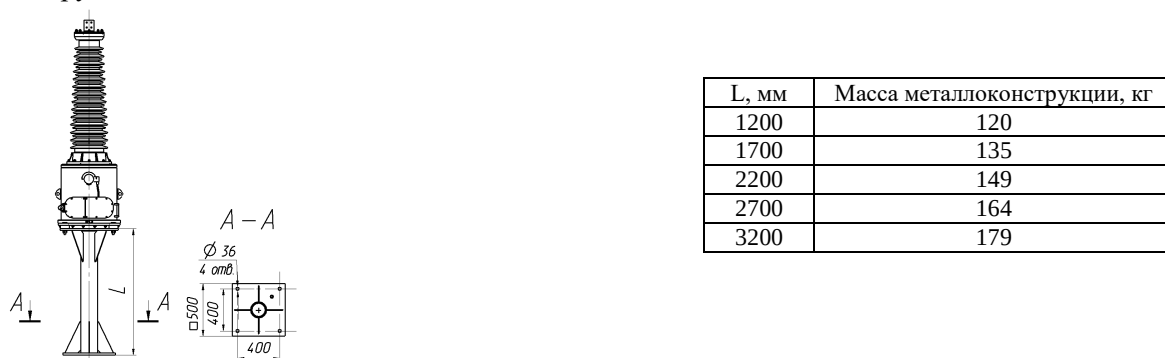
Установка одного трансформатора напряжения ЗНГ-110 на заводской металлоконструкции
